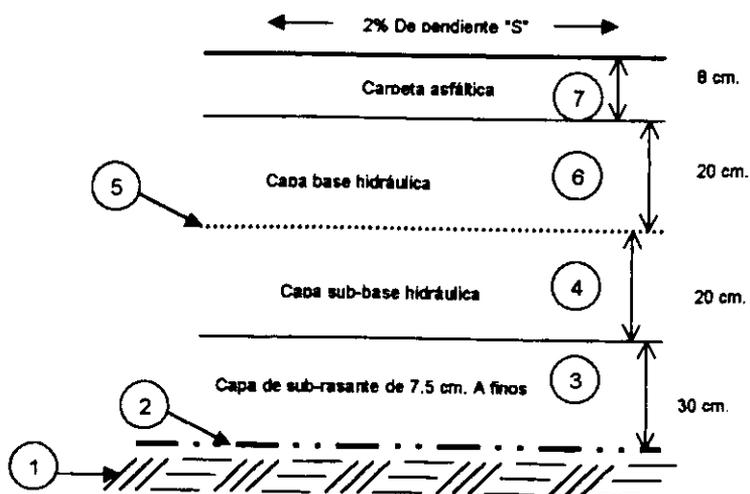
estructura de pavimento con el uso de Geotextiles
